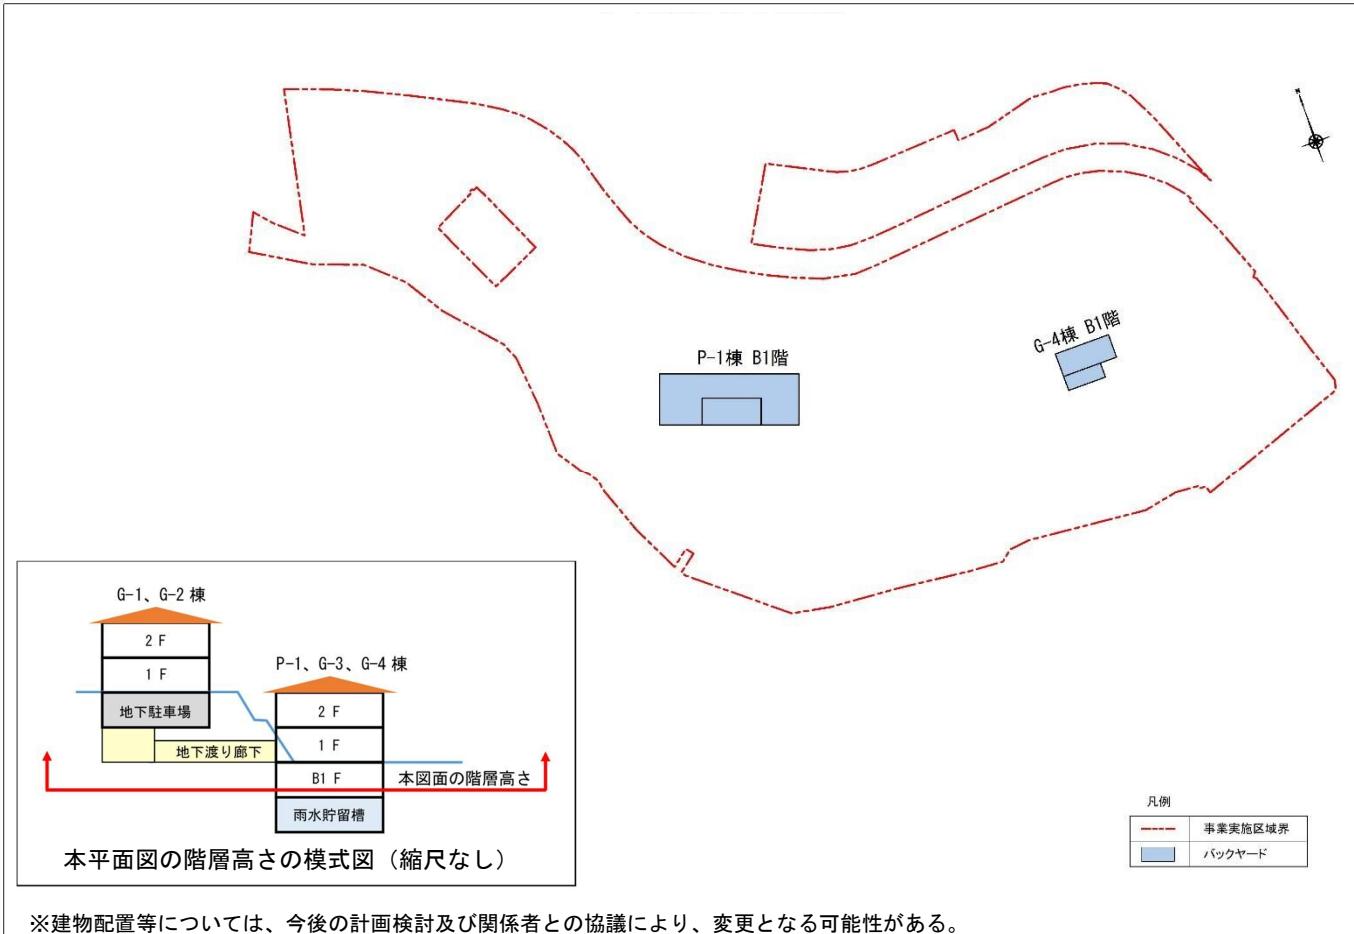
(3) 施設配置図 (各階平面図-2)
